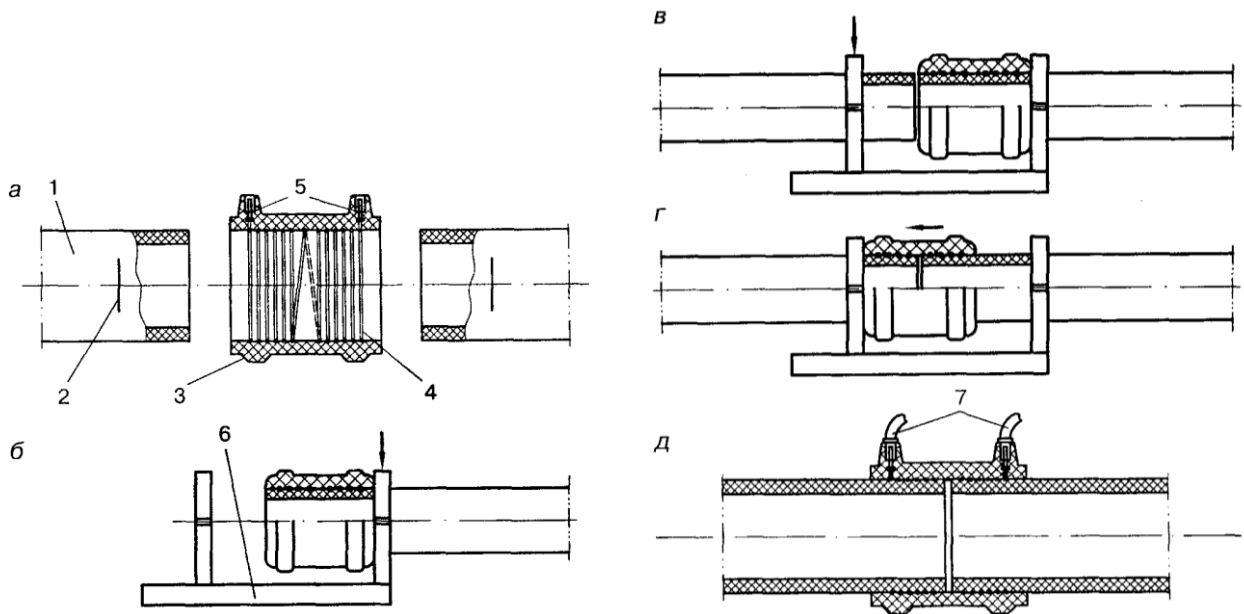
Схема соединения труб муфтой с закладным нагревателем: *а* – подготовка соединяемых элементов; *б, в, г* – этапы сборки стыка; *д* – собранный под сварку стык; 1 – труба; 2 – метка посадки муфты и механической обработки поверхности трубы; 3 – муфта; 4 – закладной нагреватель; 5 – клеммы токопровода; 6 – приспособление для сборки; 7 – токопроводящие кабели сварочного аппарата
